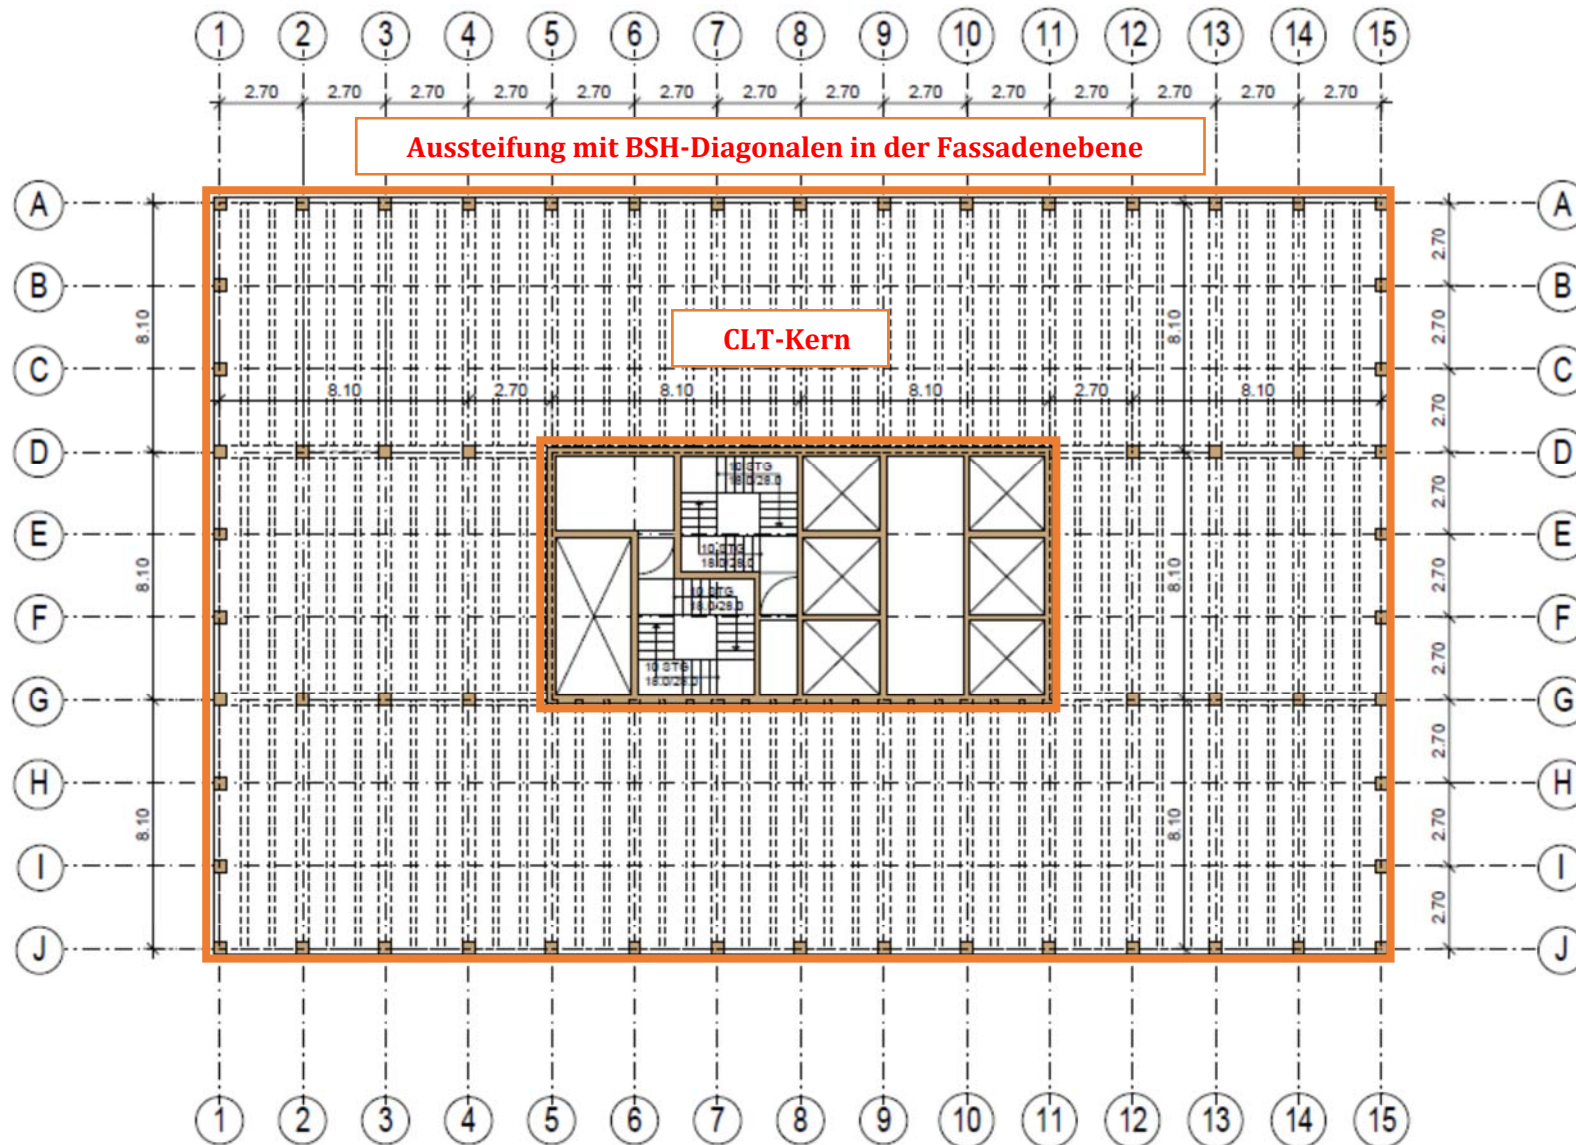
Grundriss Tragwerkstyp 2 und 3
